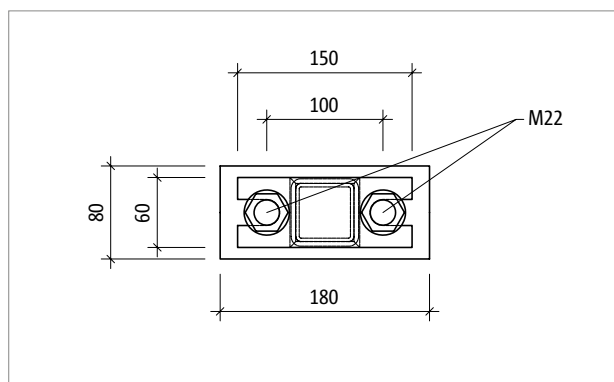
Schöck Isokorb® T typ S-V-D16: Řez prvkem
